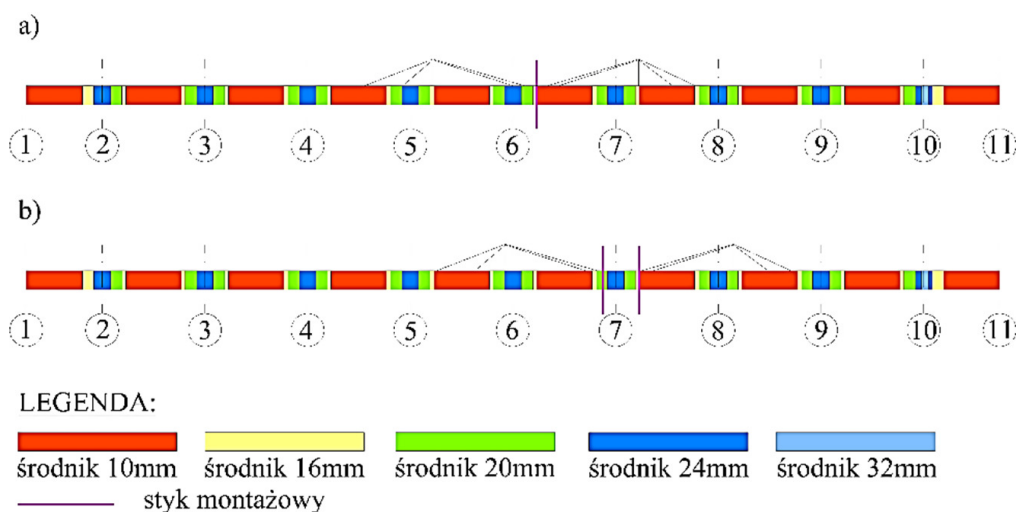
Widok z boku na filar a) projekt pierwotny nasuwania b) projekt alternatywny [3]
